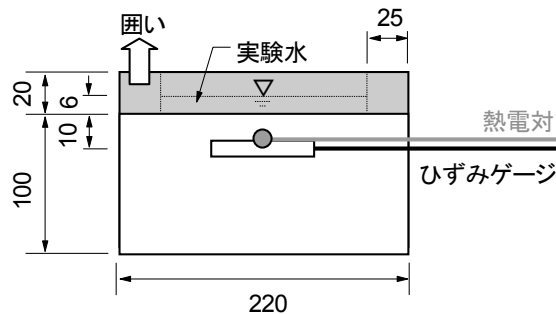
ひずみゲージと熱電対の埋設位置 (横からの断面図, 単位 : mm)
